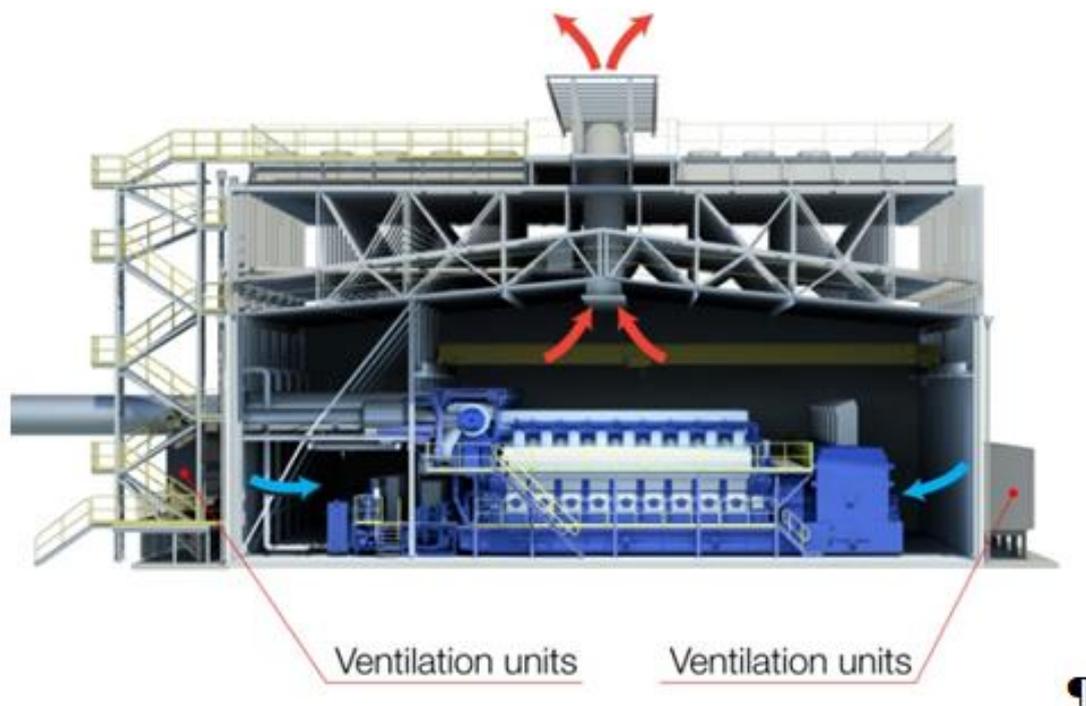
Sezione sala macchine schema tipico della ventilazione
